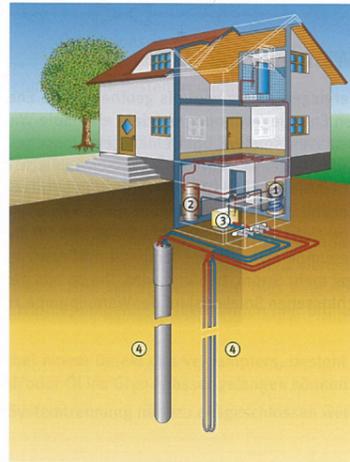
Sole-Wasser-Wärmepumpenanlage mit Erdsonden
